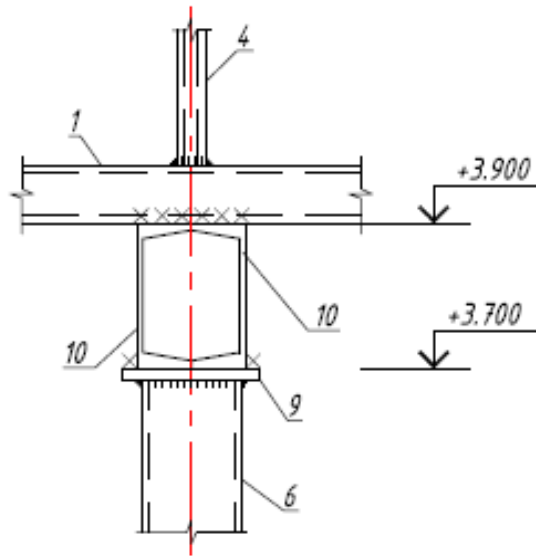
Запропоноване конструктивне вирішення вузла опирання нижнього поясу крокв'яної ферми на вертикальну стійку (вид збоку).
